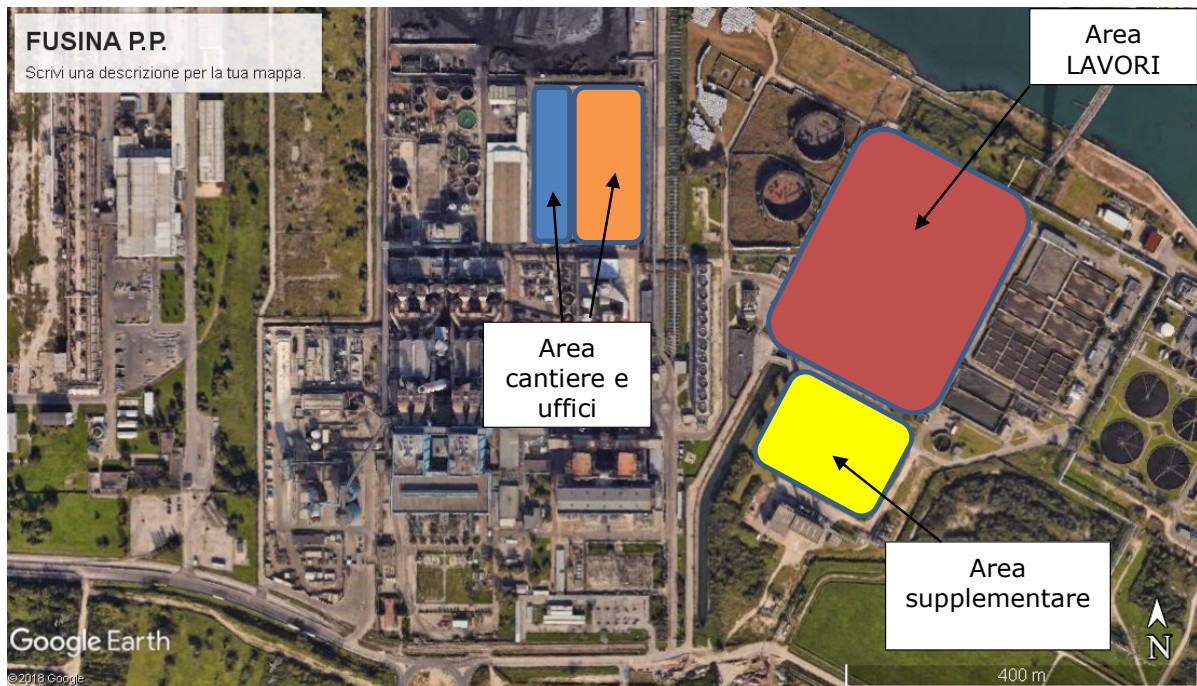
Rappresentazione delle aree di cantiere previste interne alla centrale
